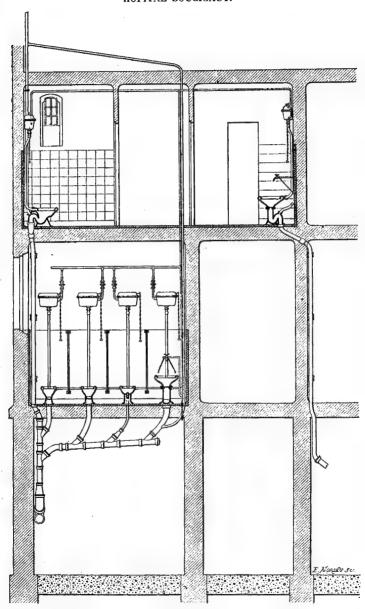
L'hôpital Boucicaut; installations sanitaires d'un pavillon de malades.
